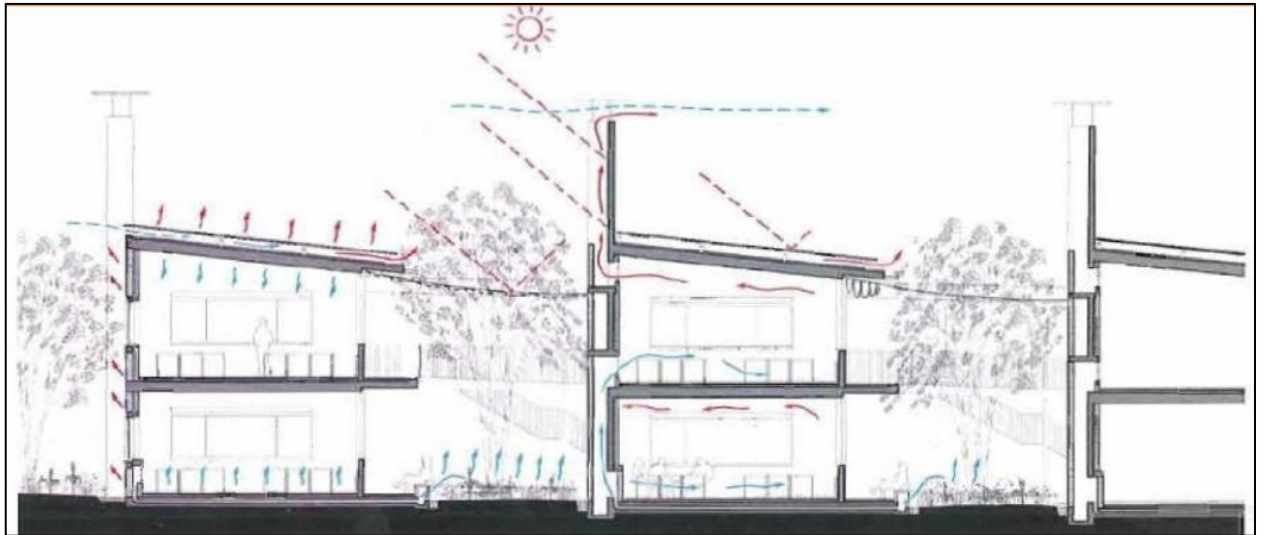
Coupe longitudinale représentative du principe de toiture ventilée, d'arrivée d'air frais par le patio et de reprise de l'air chaud par la cheminée solaire.
